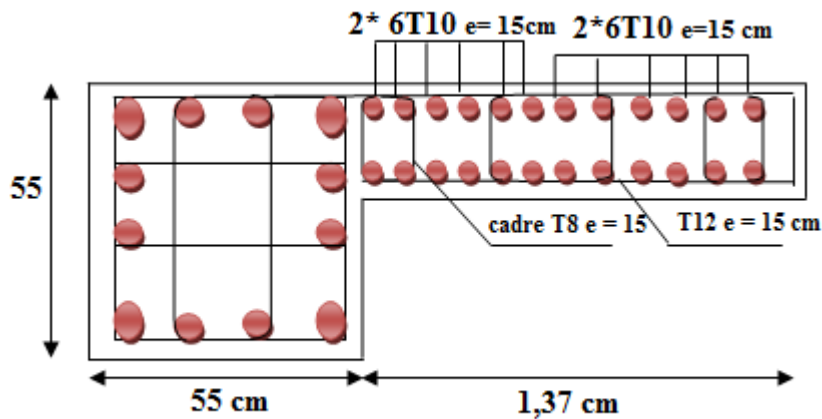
Détail de Ferrailage du Trumeau (T3) (T3') , coupe horizontale.
